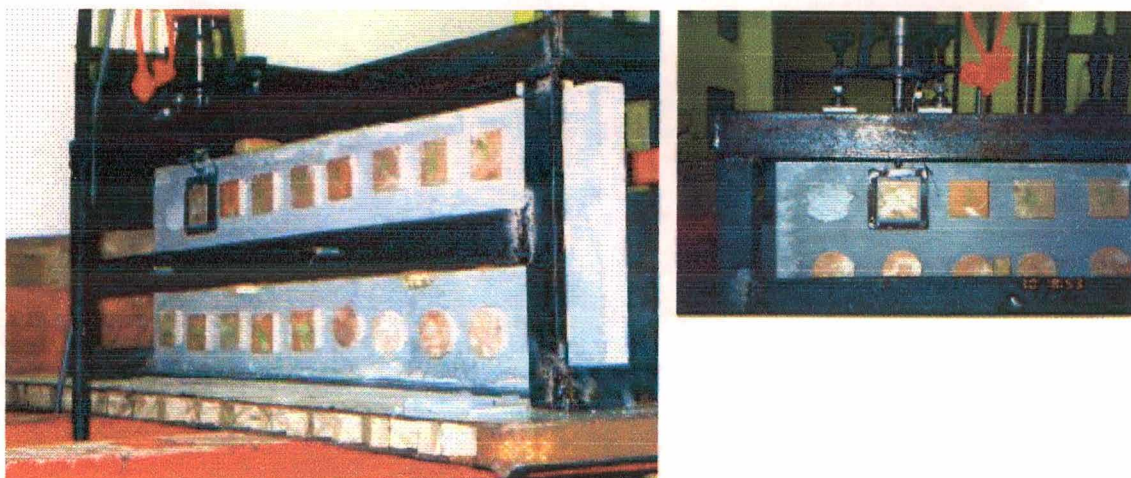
Substrato fixado ao suporte, com caixilho metálico posicionado na cerâmica de teste.
